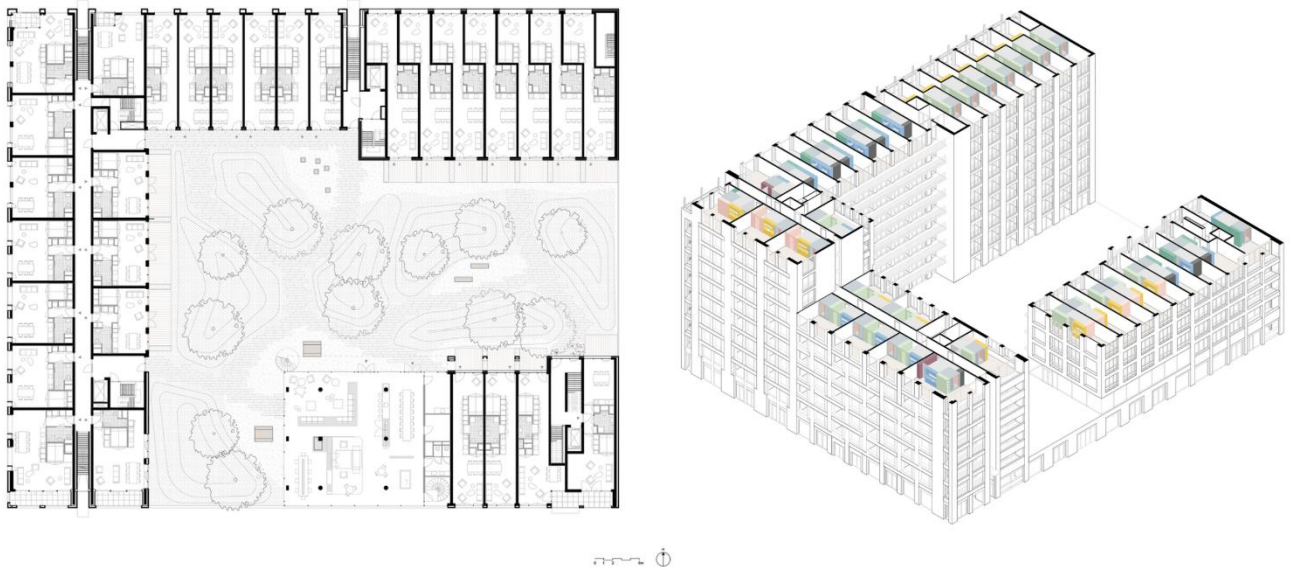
, 2.21 – Перший поверх будівлі та її горизонтальний розріз [11]
